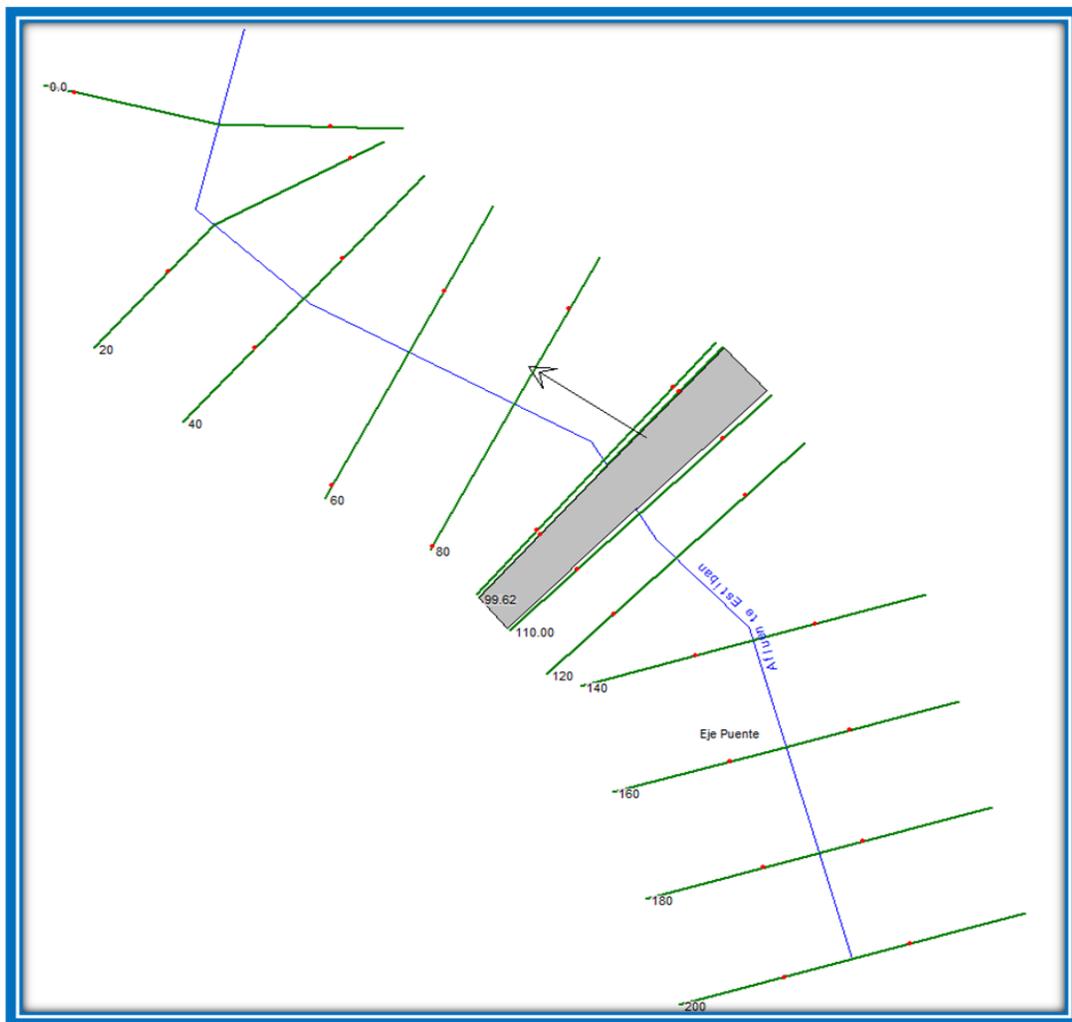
Esquema del puente sobre el Río Cacao y las secciones transversales
